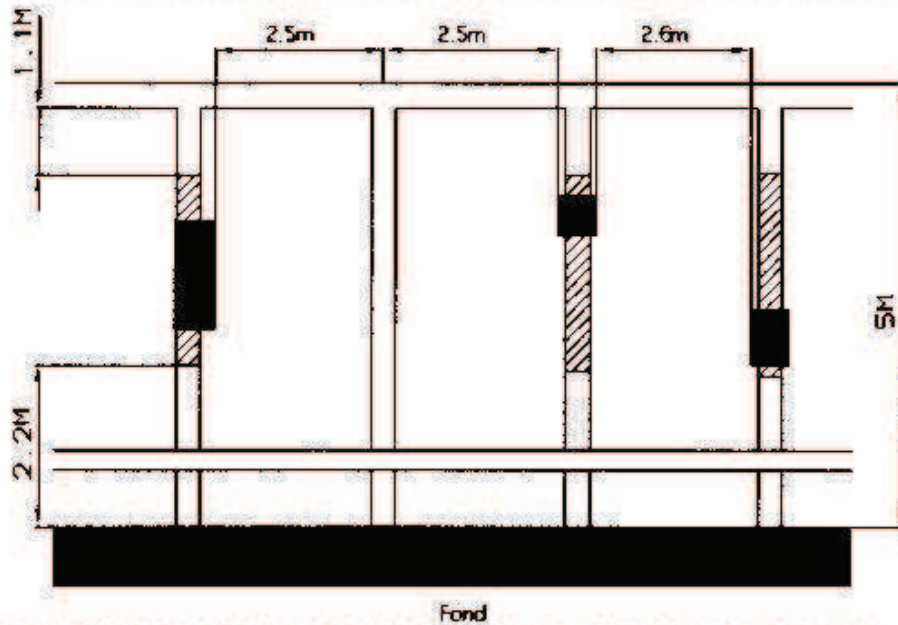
Places de classes A - Application des tableaux 2 et 3 à un rangement en bataille
